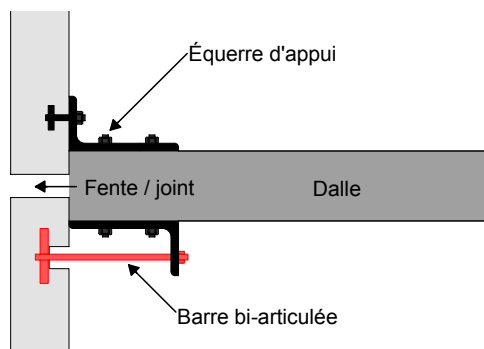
> Consolidation d'éléments de façade par des barres pendulaires
